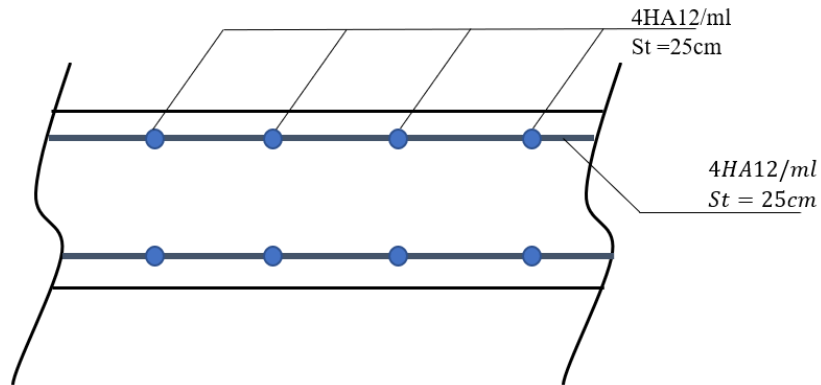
Coupe de ferrailage pour plancher à dalle pleine
